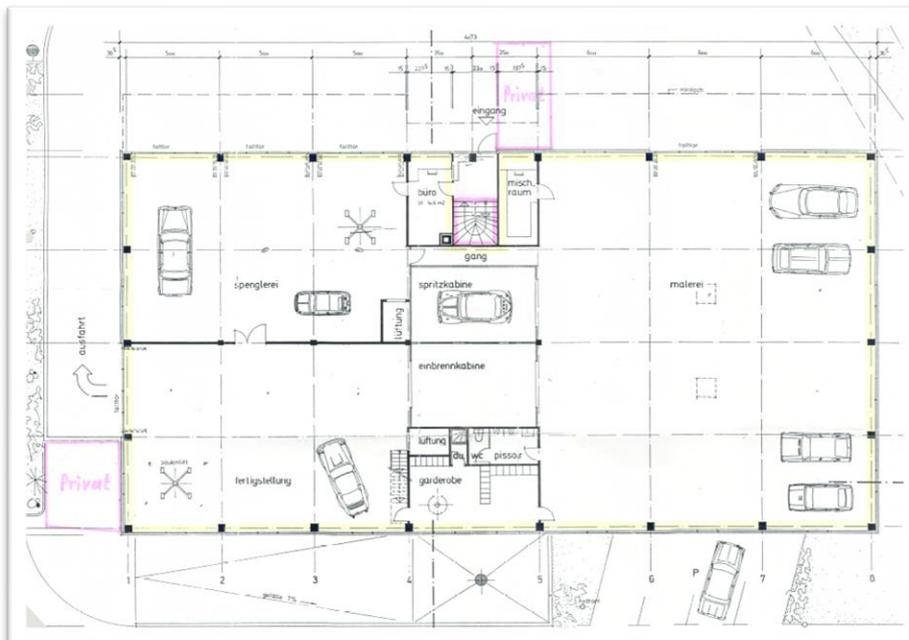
; Grundriss EG Merbag-Gebäude
